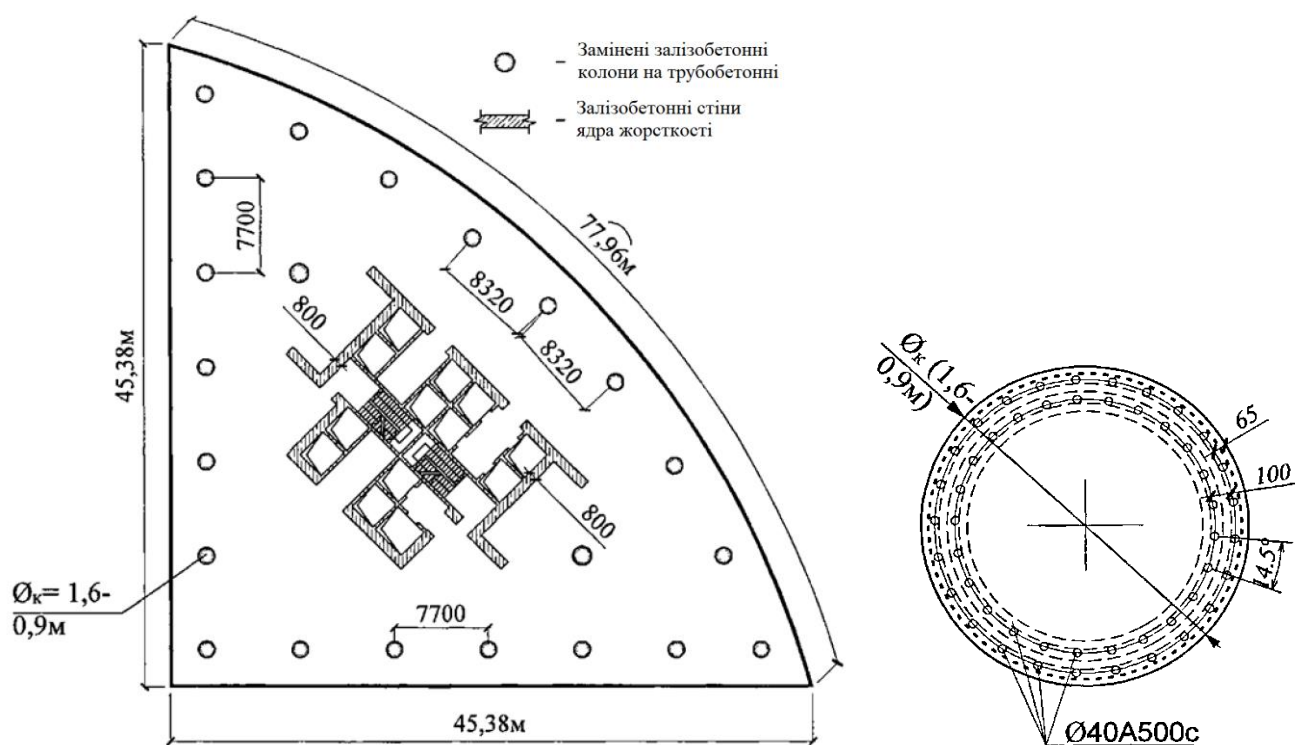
План типового поверху комплексу «Mirax Plaza», армування залізобетонної колони
